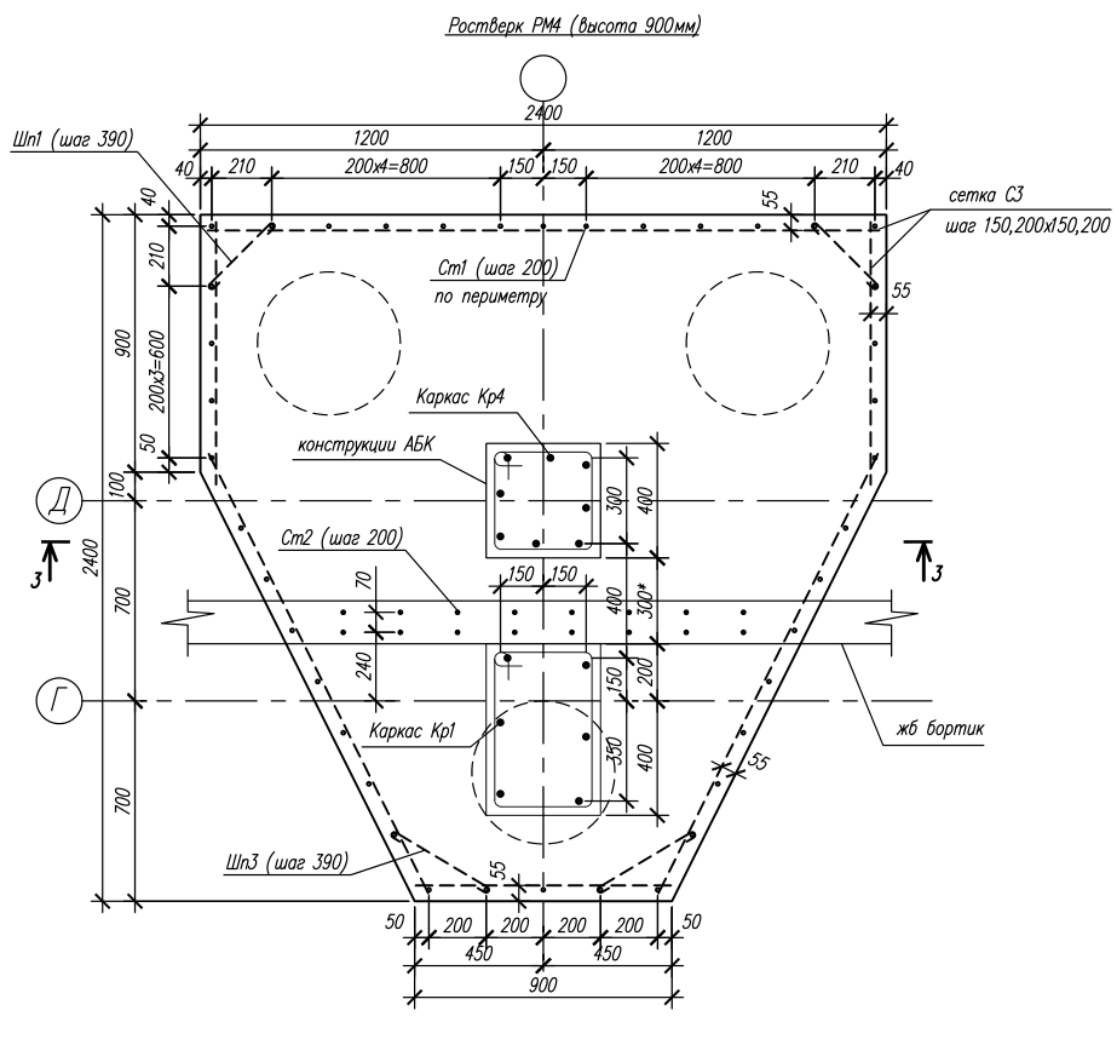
/1 Ростверк общего фундамента здания склада и АБК
